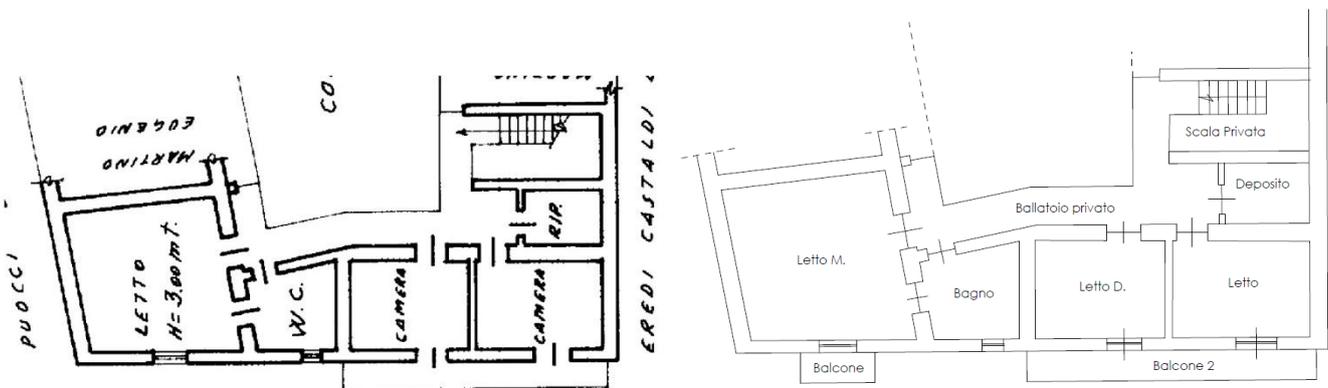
Planimetria catastale dell'immobile al piano primo e grafico del bene all'attualità.
